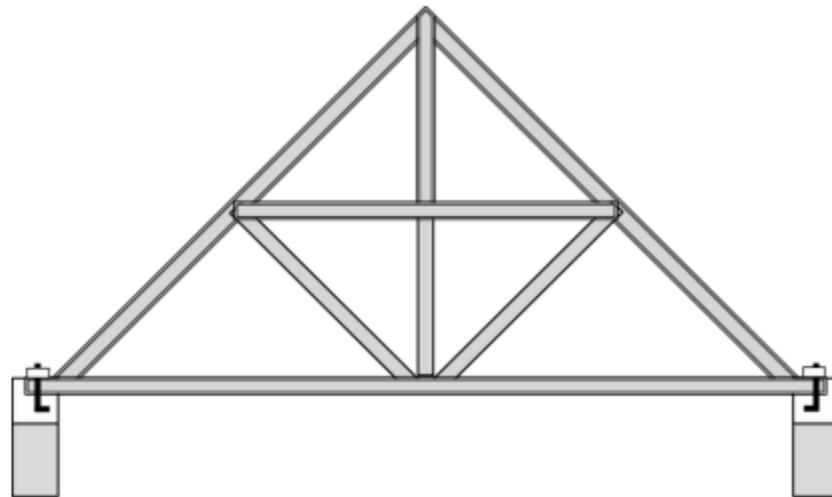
exemple d'ancrage de la toiture dans les chaînages
